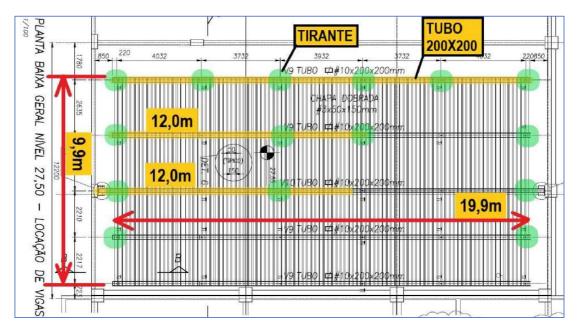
planta baixa com estrutura do piso cenotécnico já montada.
